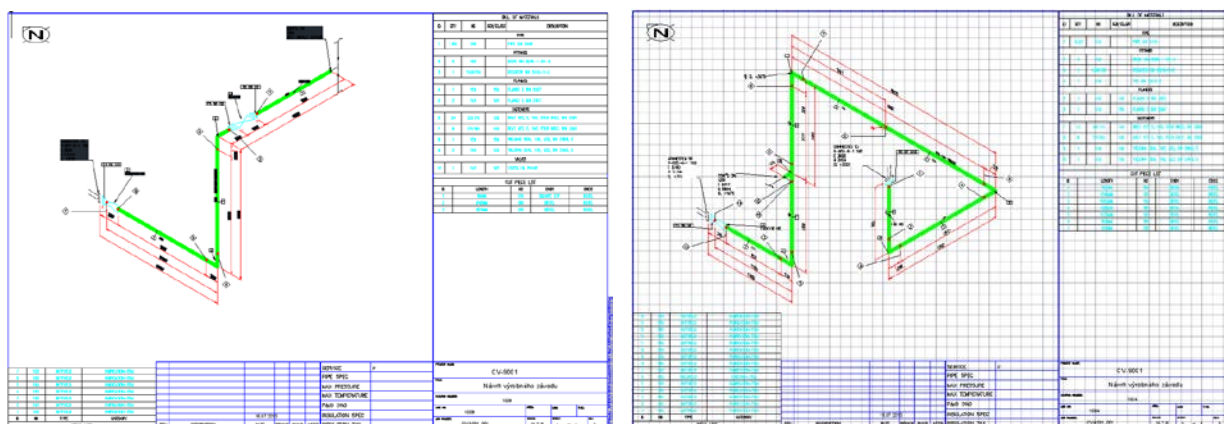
Upozornění - generuje se izometrie / je vytvořená izometrie
